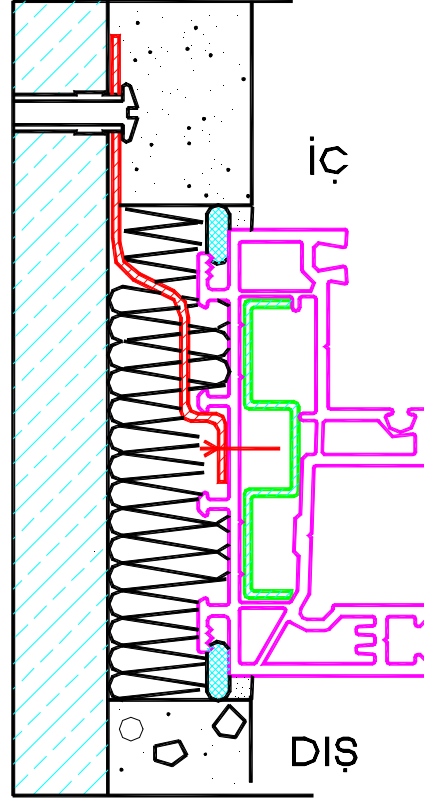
Kenet lamalı montaj detayları : ( Yan ve Üst detaylar )
